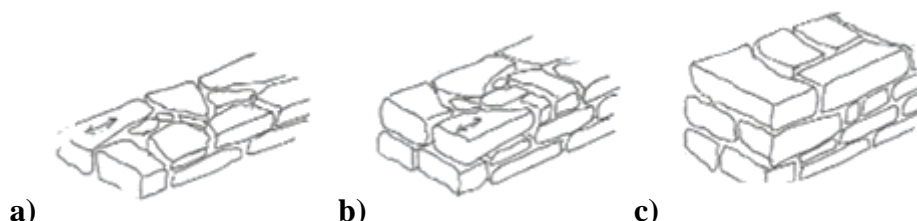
Sequência de execução de topos: a) Colocação de sogas e tijolos na primeira fiada; b) Cruzamento de sogas e tijolos, na segunda fiada, com a primeira; c) Travamento final com perpiano
